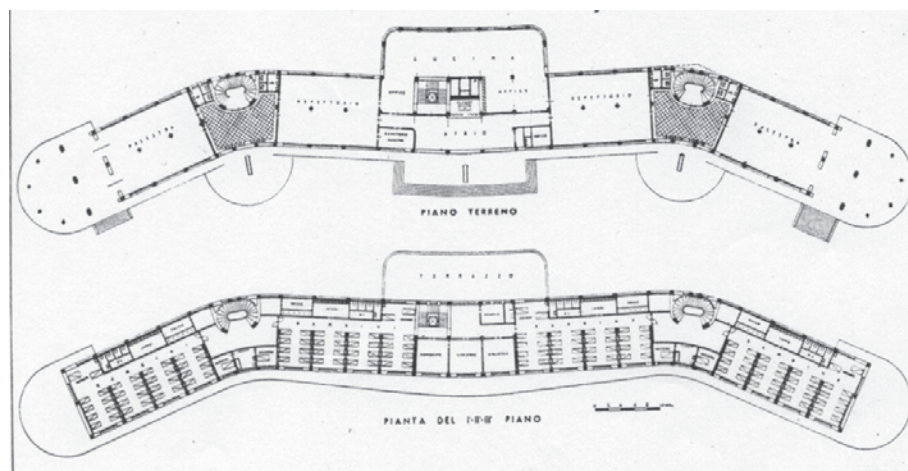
Ferienkolonie „IX Maggio“: Grundriss EG / OG
